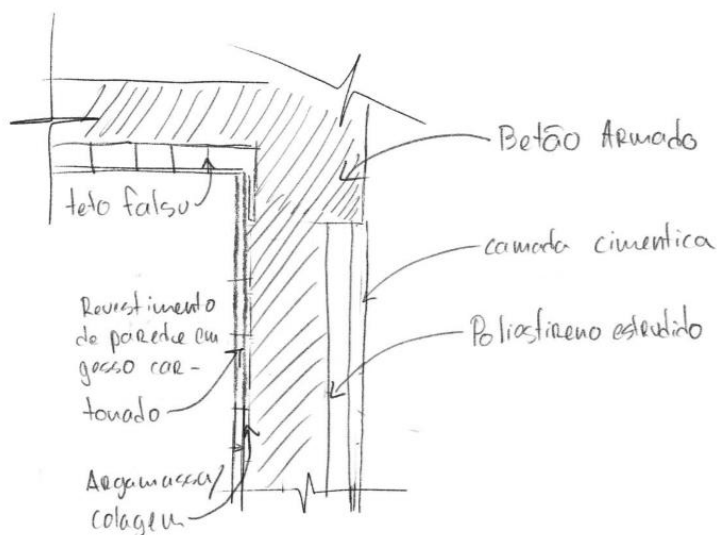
Pormenor construtivo da parede exterior com a alvenaria
